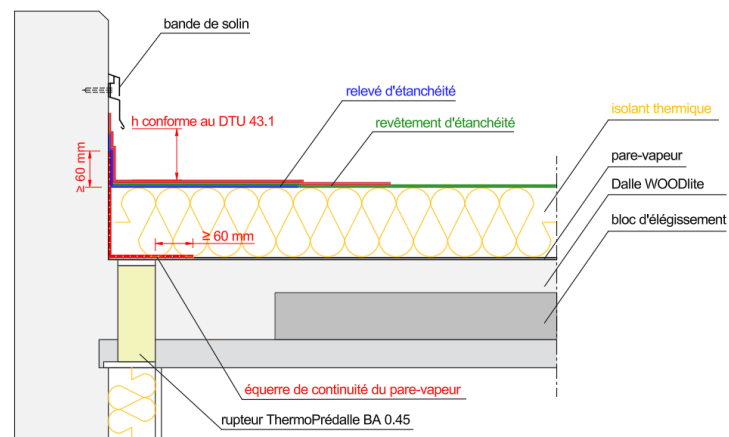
exemple de disposition d'étanchéité en toiture-terrasse
